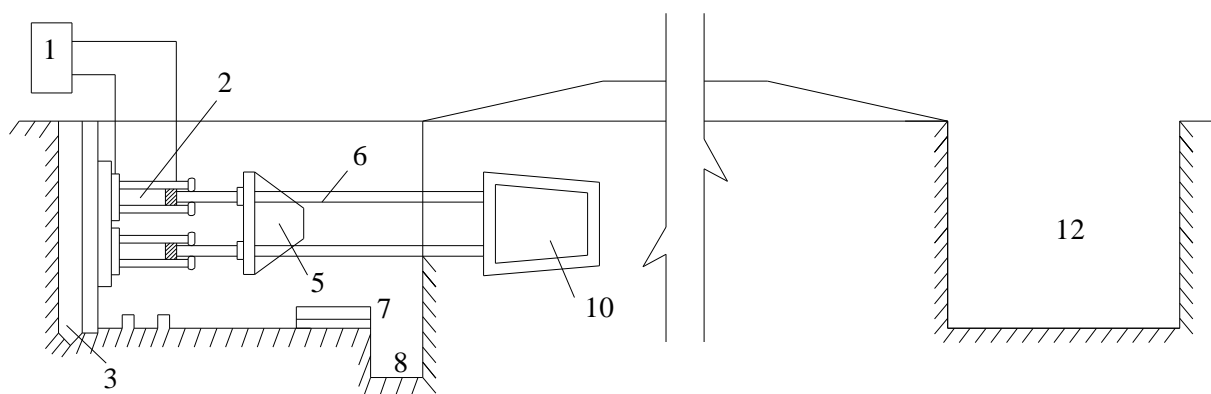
Схема бестраншейной прокладки газопровода методом прокола:
